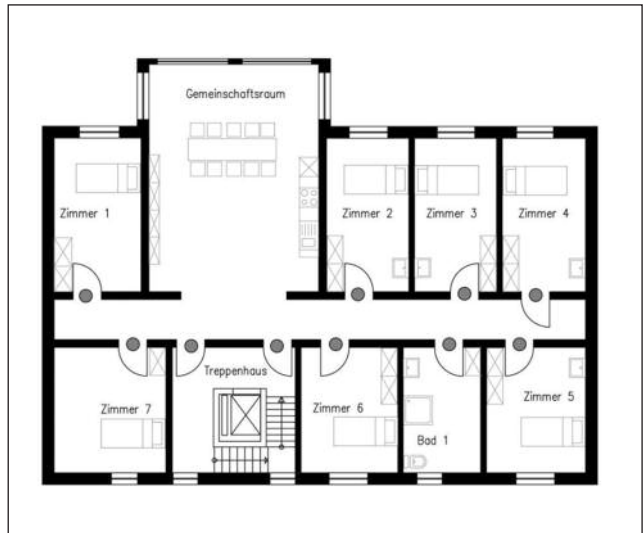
Beispiel Grundriss, vierstöckig, mehr als zweihundert Quadratmeter
